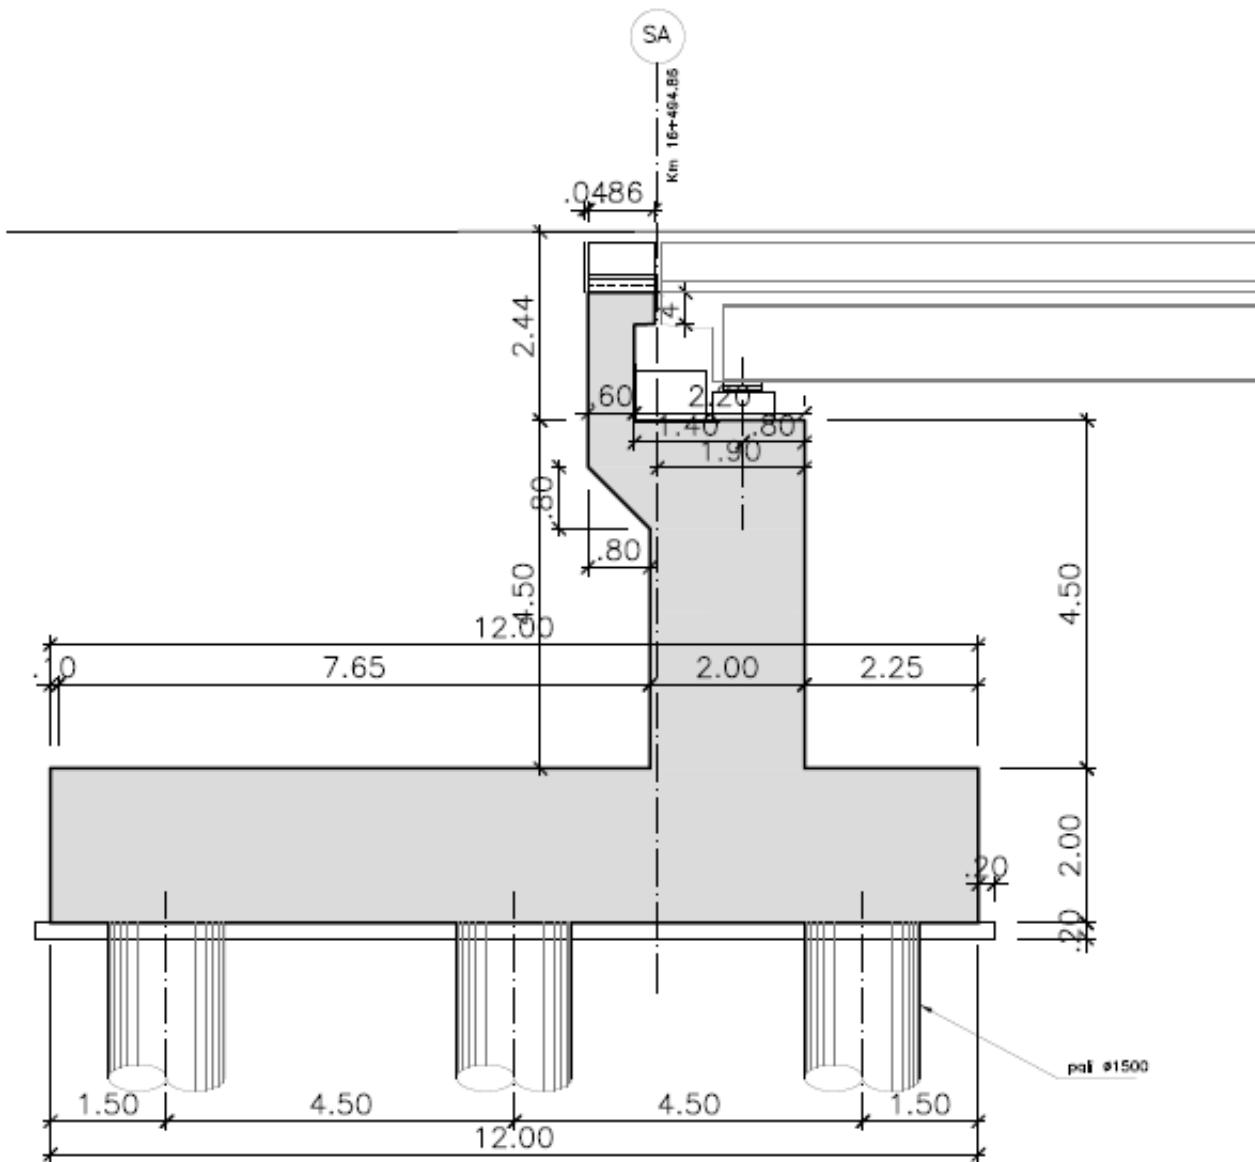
Sezione longitudinale Spalla "A".
